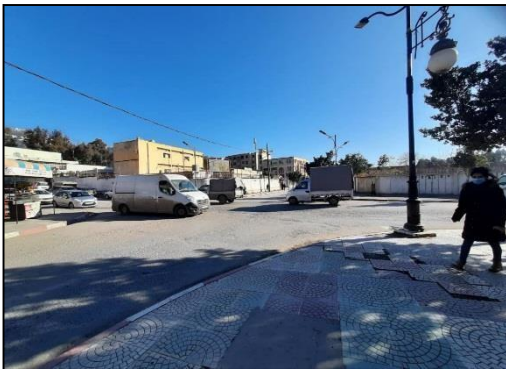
photo sur l'intersection BOULLILA-KESRI avant les interventions
